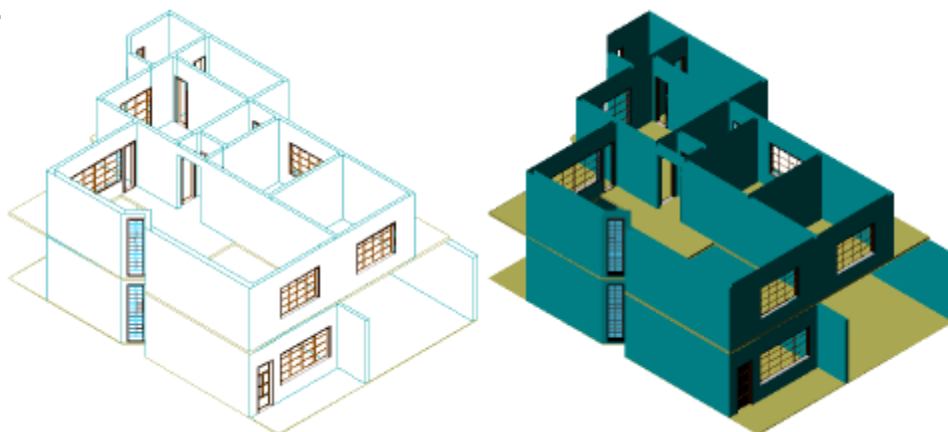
Construção das paredes do segundo pavimento. Com Hide e Shade aplicados
